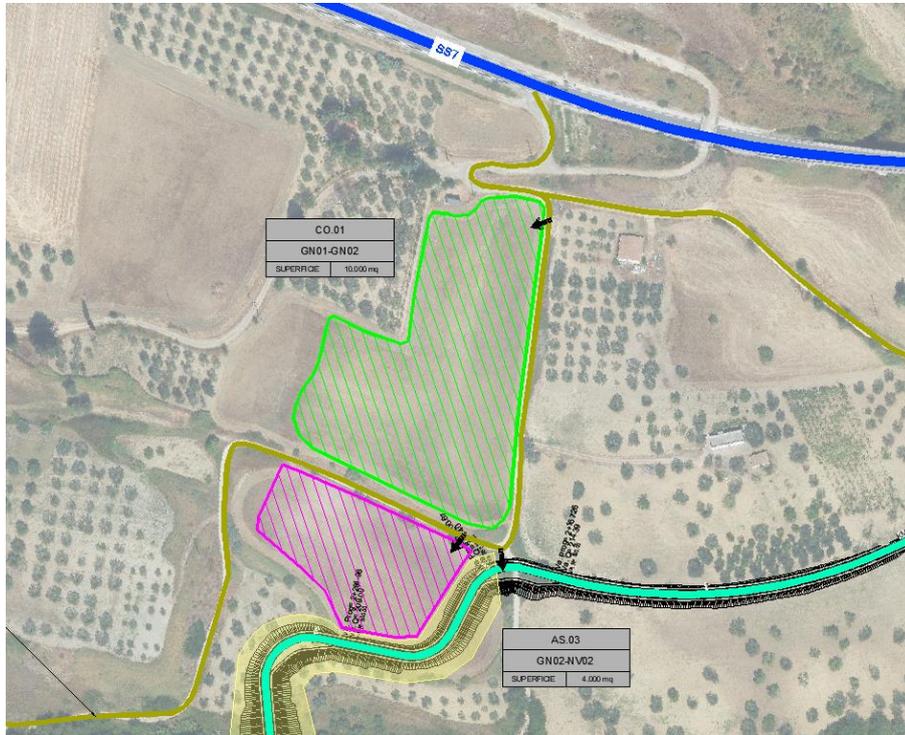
Ubicazione planimetrica del cantiere CO.01 (area verde in alto)
